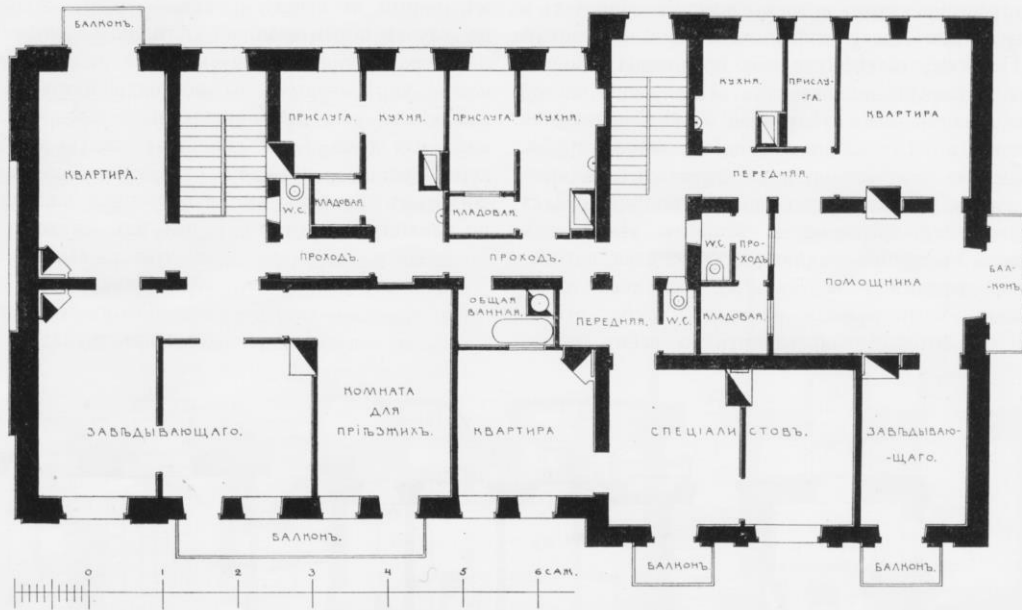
Главное здание Станции. Планъ верхняго этажа (съ натурь).
